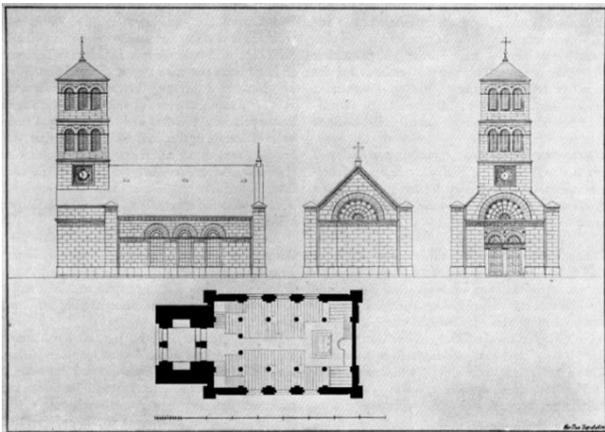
Planta para a construção de igrejas prussianas com torre, 1827. SCHUBERT, 2013, p. 67.
